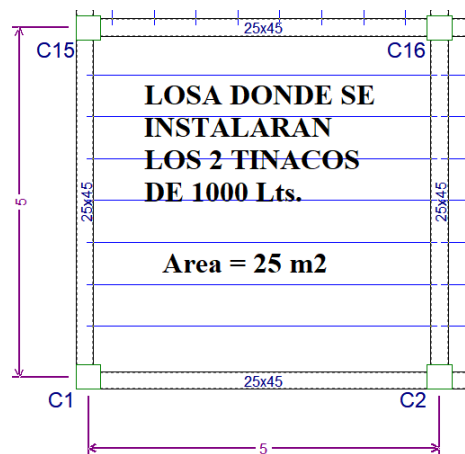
Losa de apoyo de tinacos (fuente: CYPECAD 2017)
